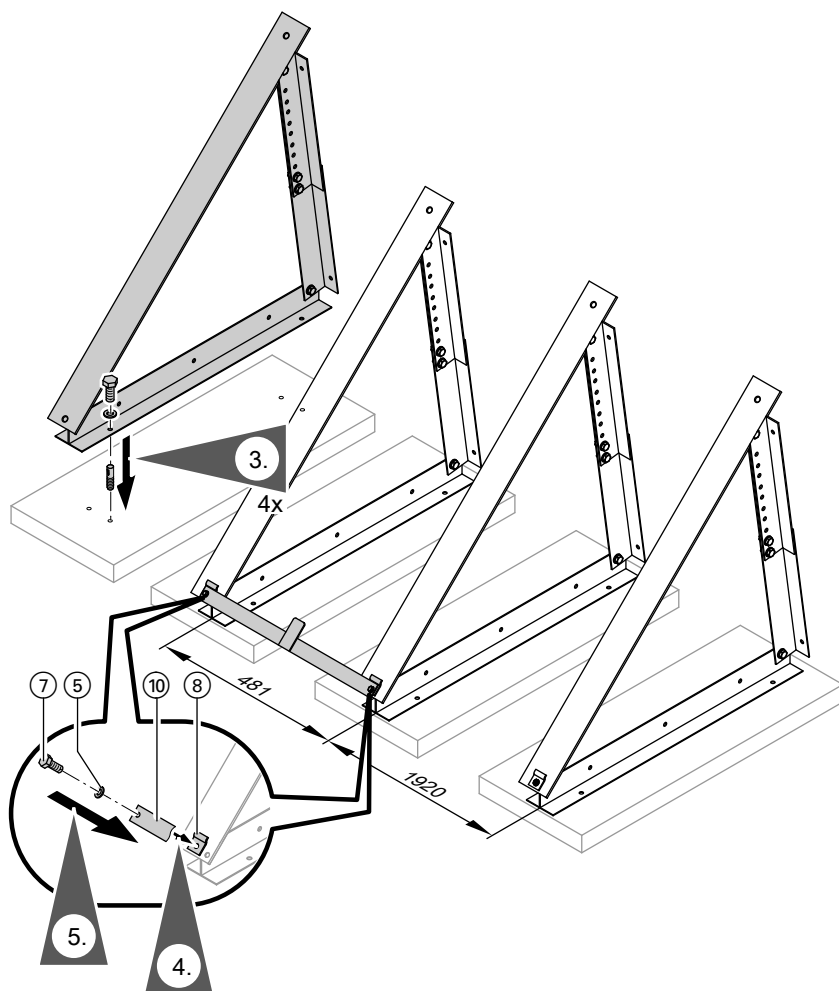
Использовать опорные стойки в качестве шаблона для сверления.
